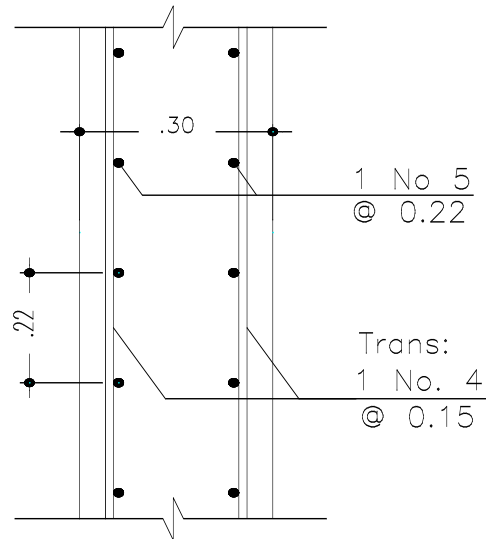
Armado de columna propuesta y chequeada para edificio de muros
